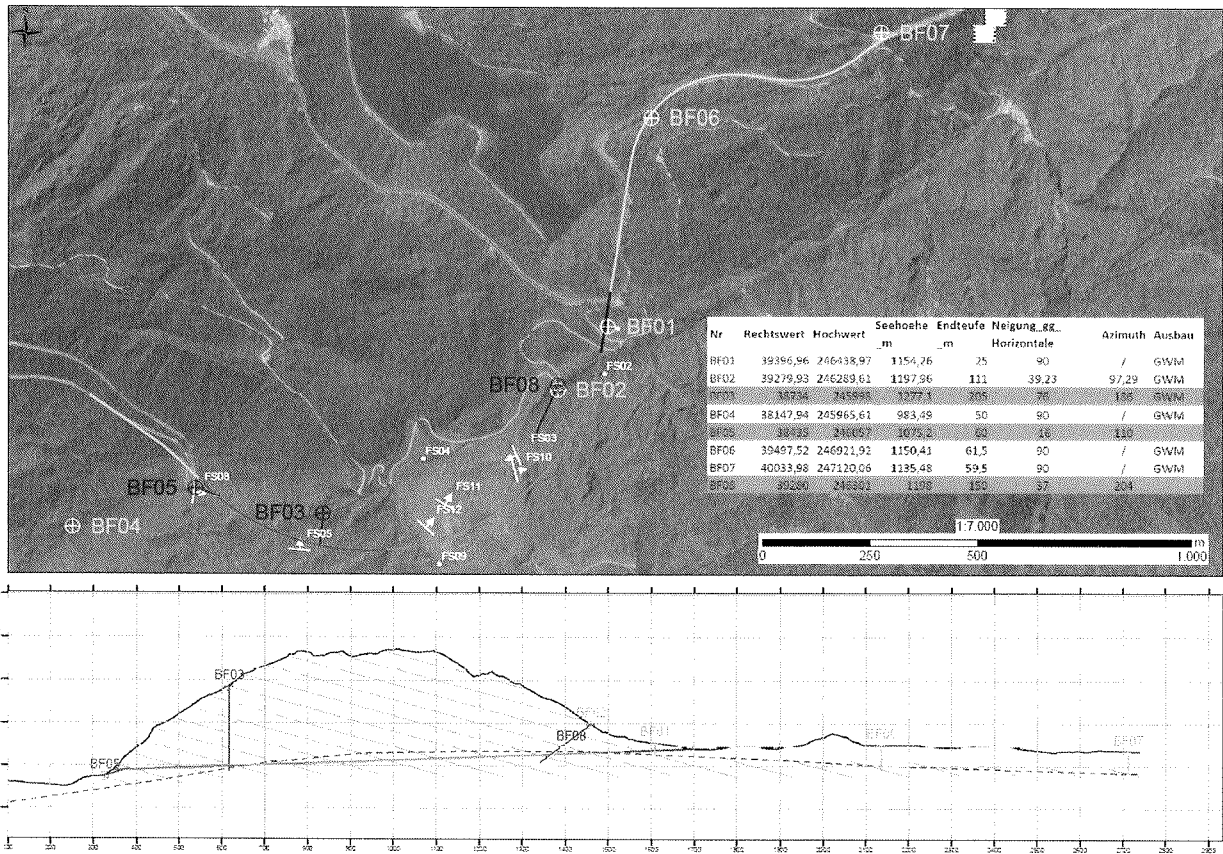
Lageplan der Erkundungsbohrungen und geologischer Längenschnitt
